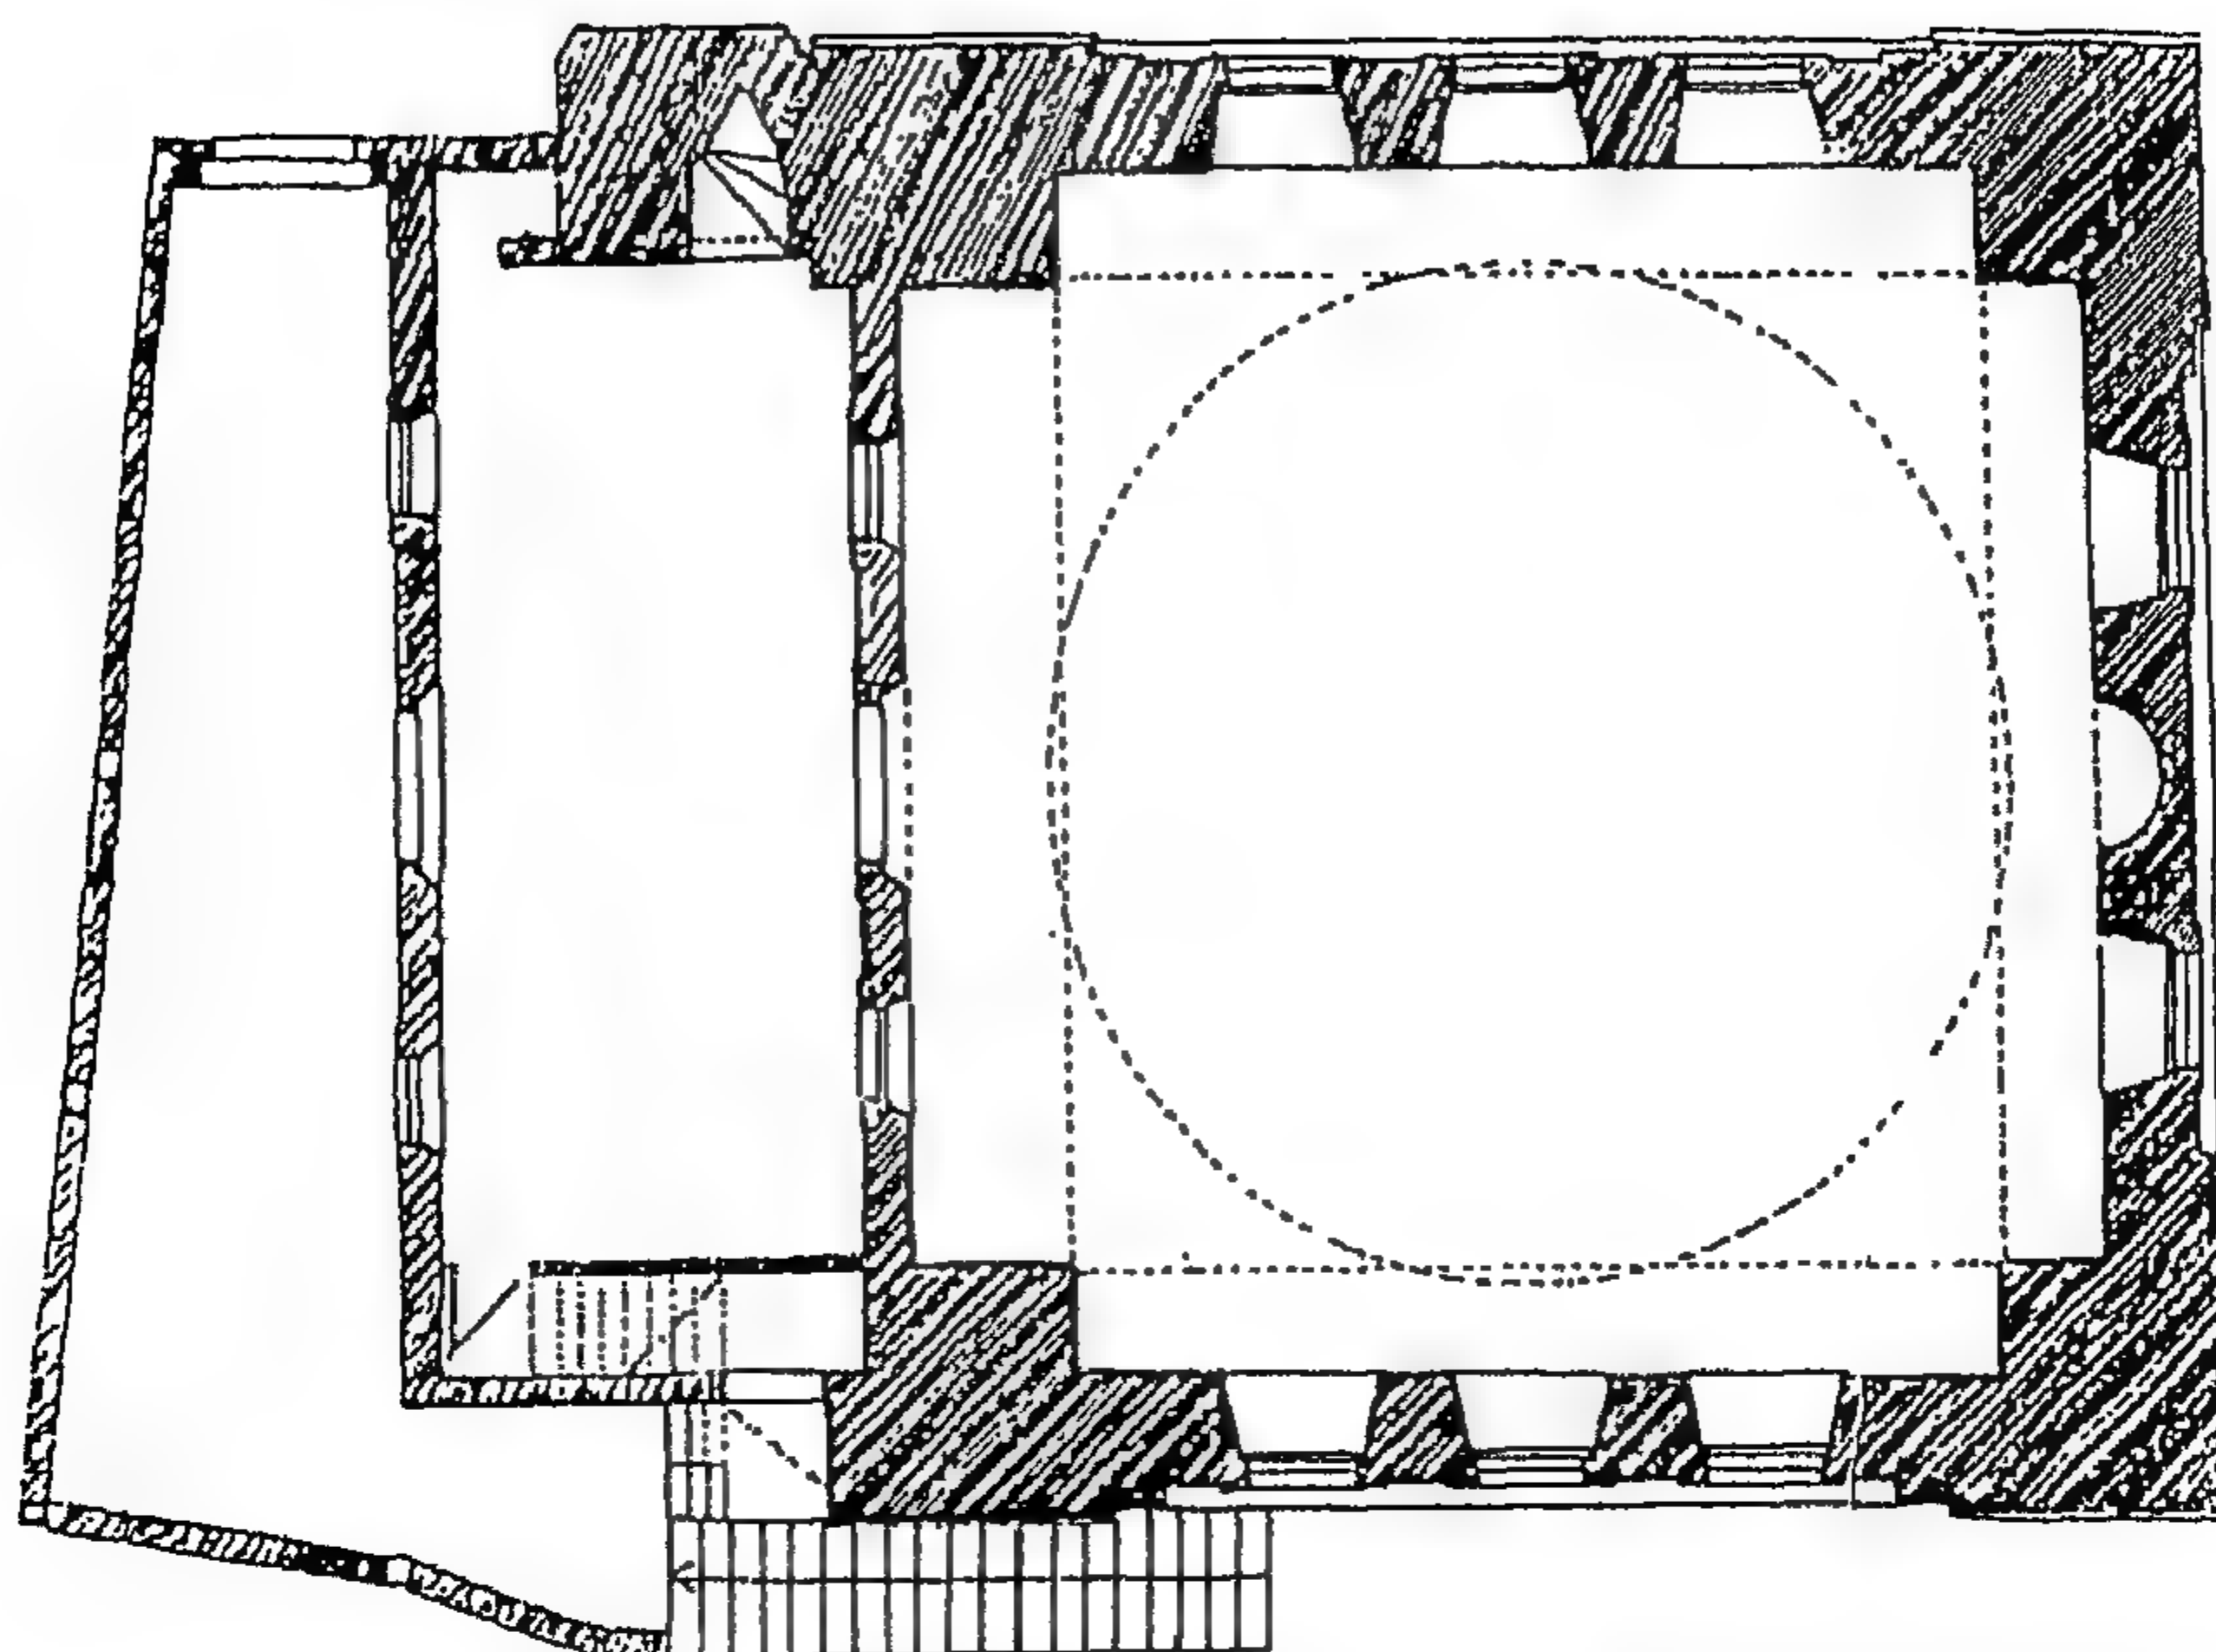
مسقط أفقي لمسجد الشيخ لطف الله في أصفهان
